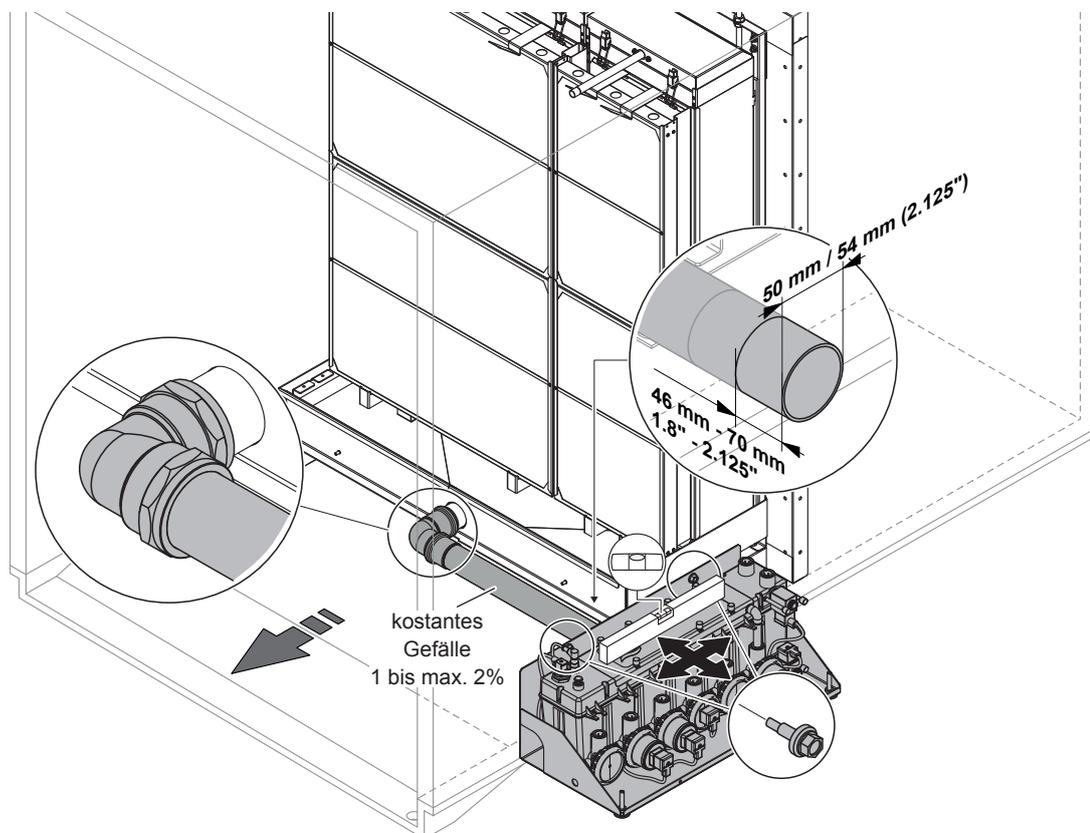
Hydraulikmodul montieren, Aussenmontage, Wassertank mit Zentralablauf
